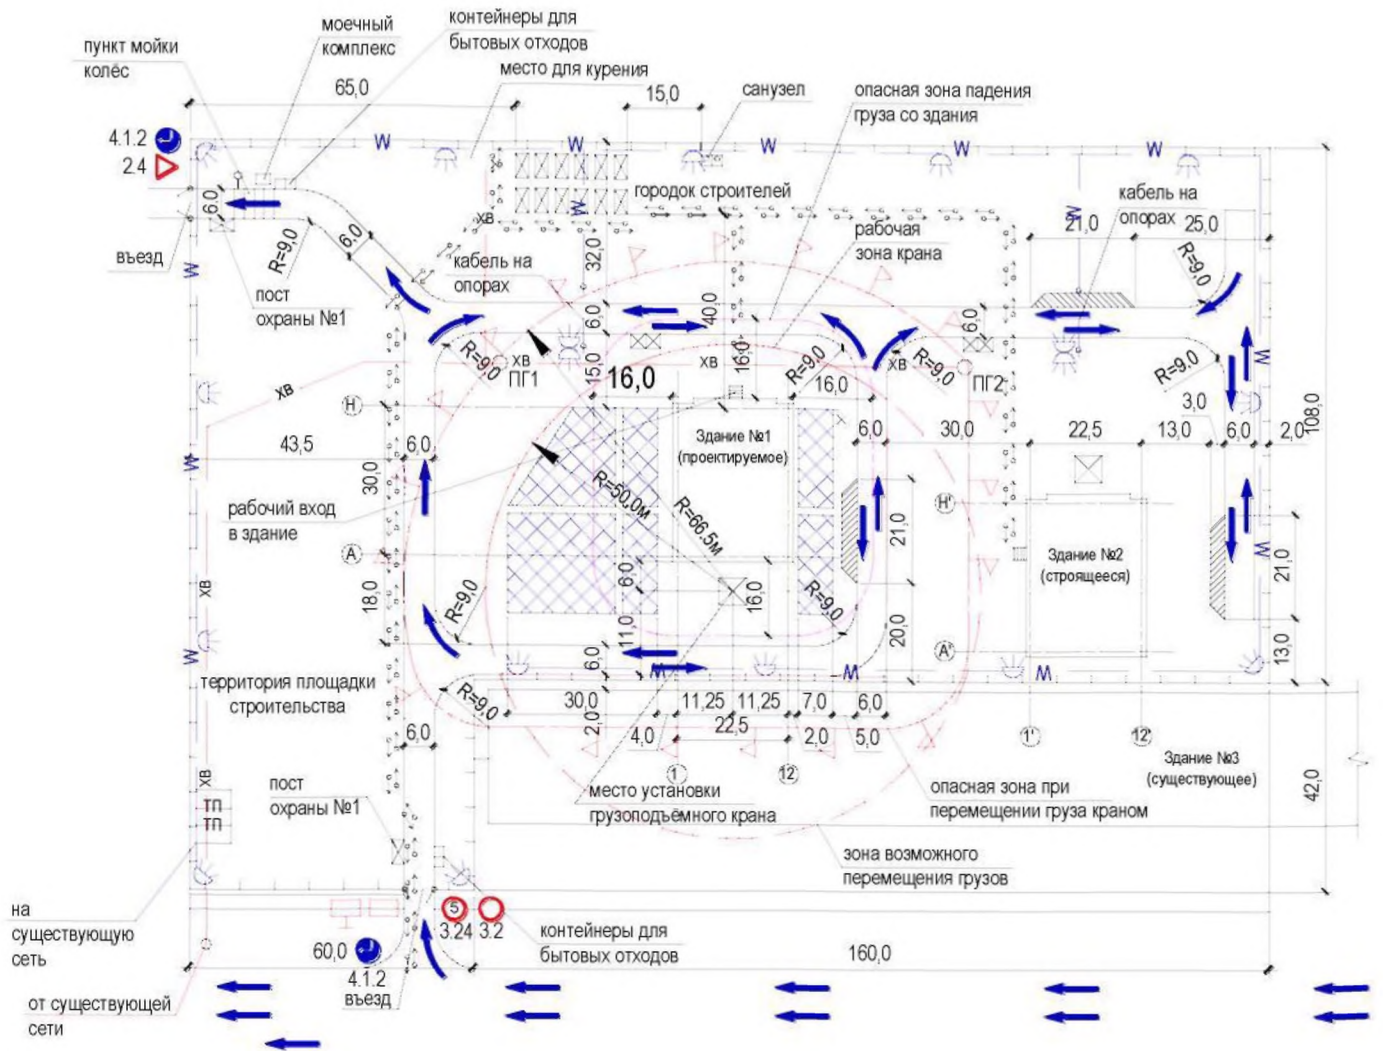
Схема сетей временного водоснабжения строительной площадки
